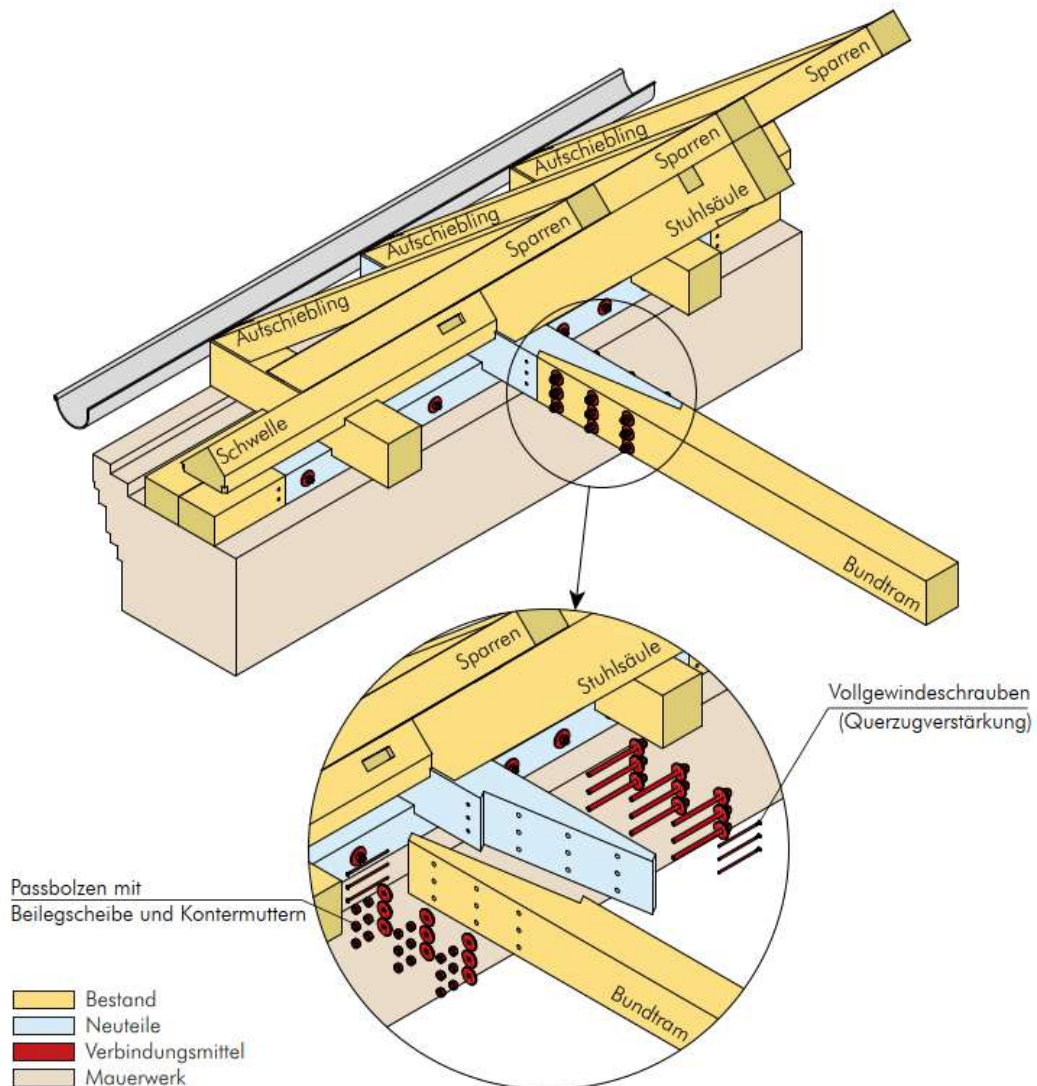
Instandsetzung eines zerstörten Bundtrames mittels schrägem Blatt mit schrägem Stoß in 3D – Ansicht, sowie Detail der Verbindung als Explosionszeichnung
